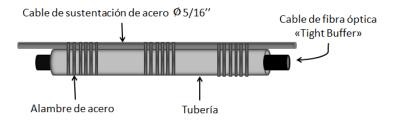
Soporte de tubería aérea Fuente: Autores
